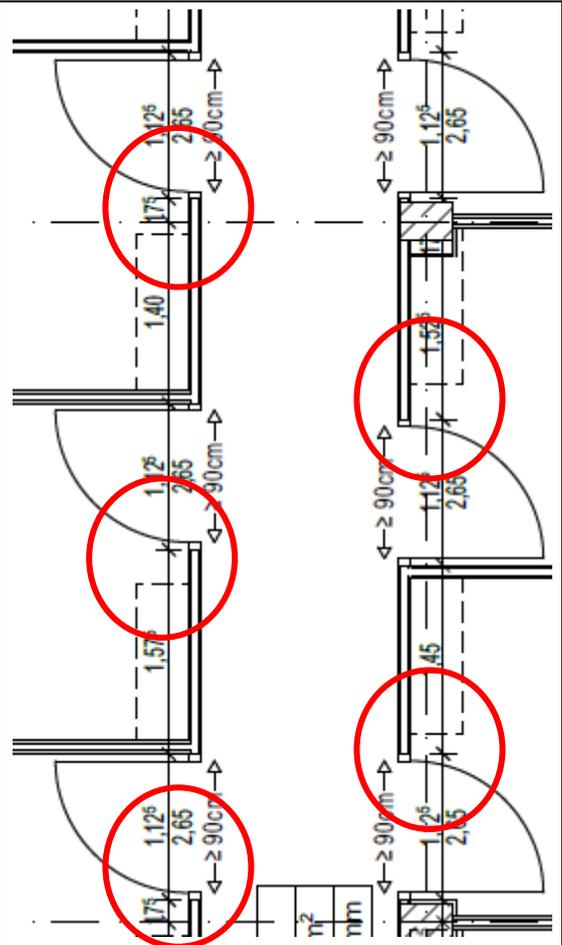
Möblierung zu dicht an den Bürotüren (betrifft alle Geschosse)
